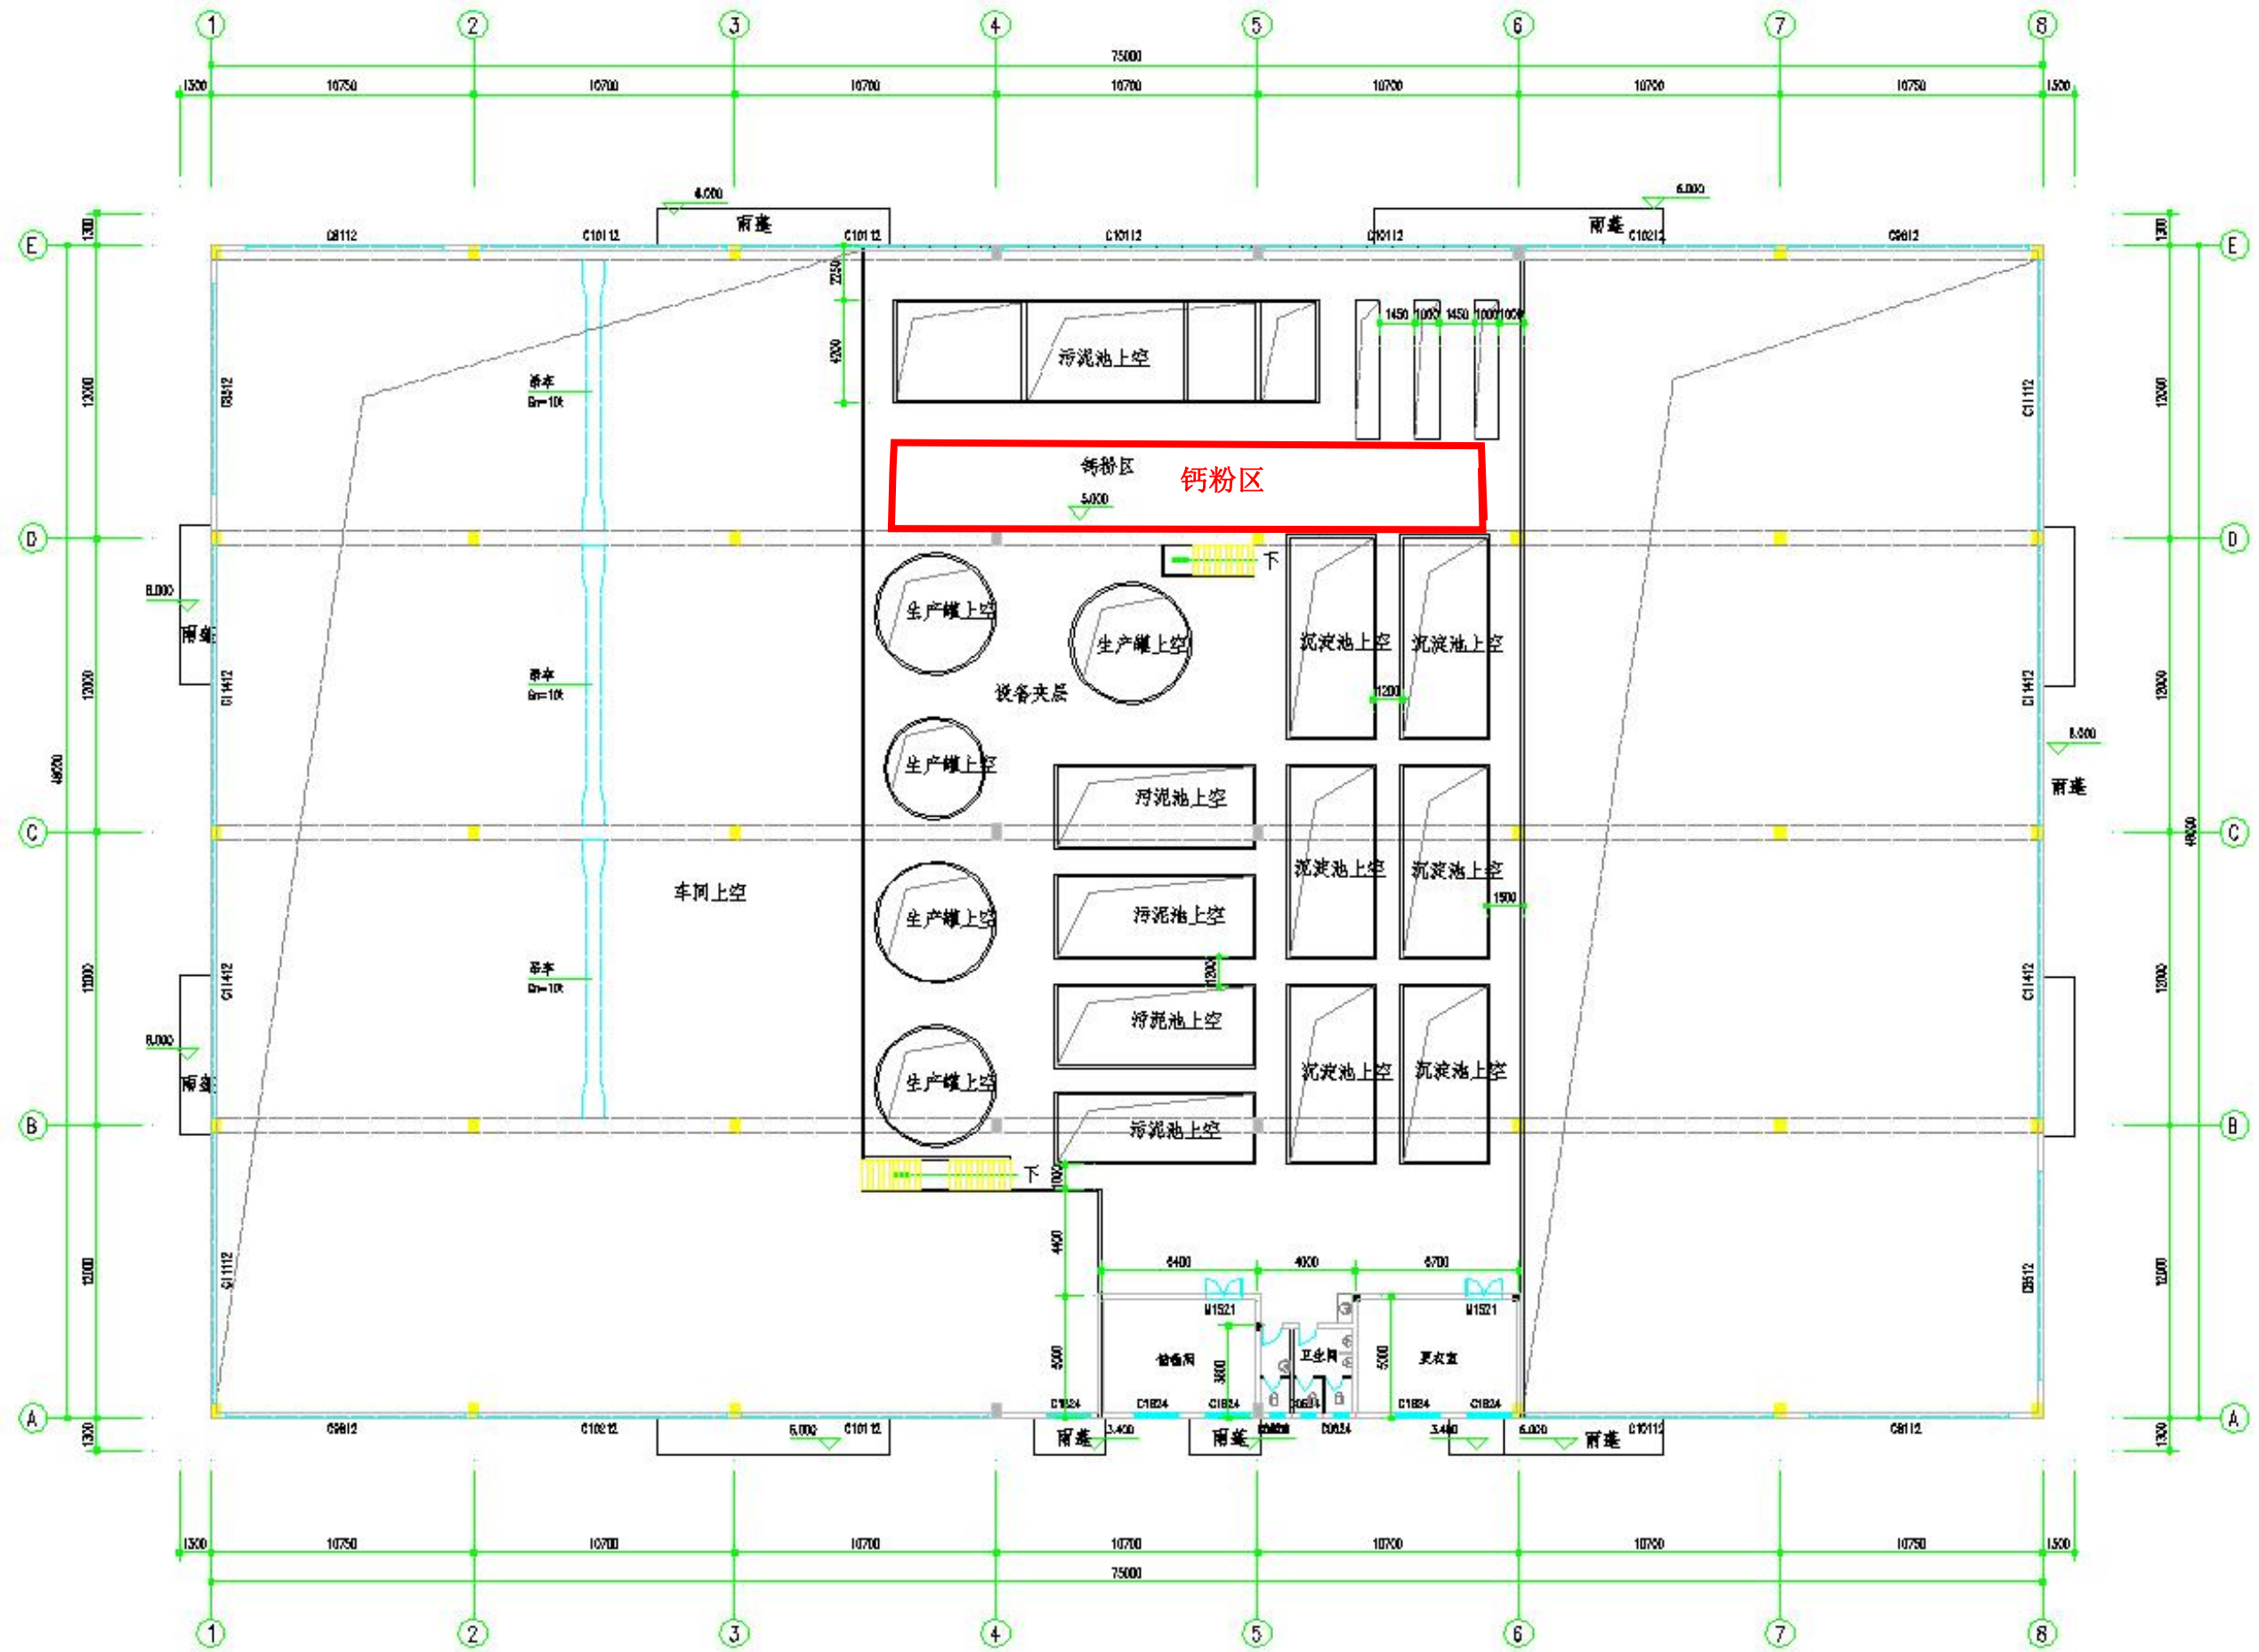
净水剂生产车间（车间一二层）平面布置图
